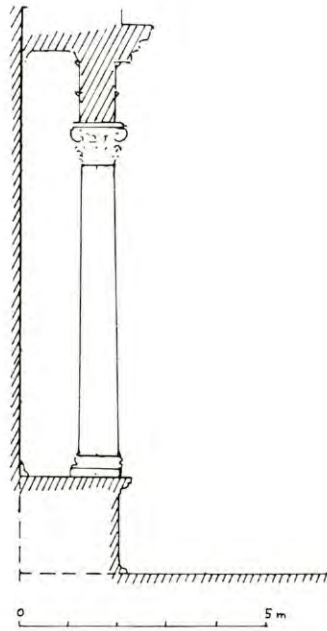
Tarragona, Catedral, Patio de la Secretaría, corte por la pared norte con reconstrucción hipotética del zócalo.
